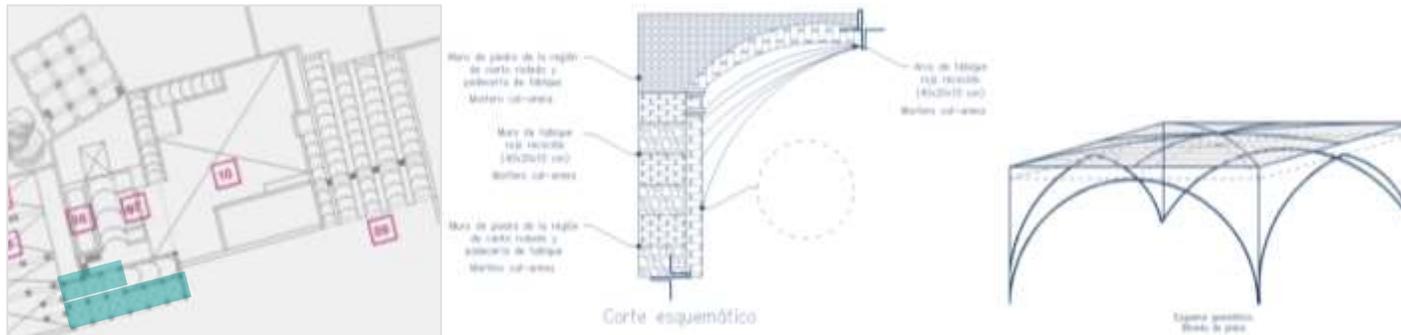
Tipología de bóvedas planas de mampostería de tabiquería
